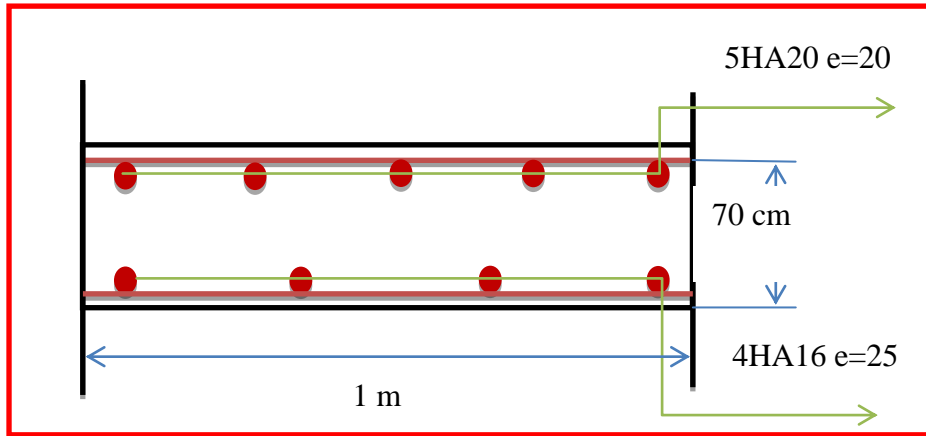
Ferrailage de la dalle du radier (sens xx).
